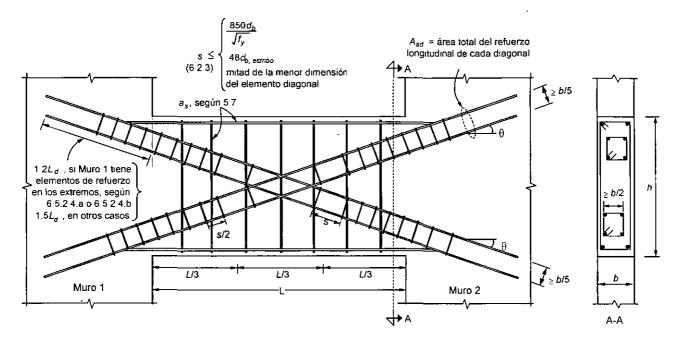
Refuerzo de una viga diafragma que une muros sujetos a fuerzas horizontales en su plano
